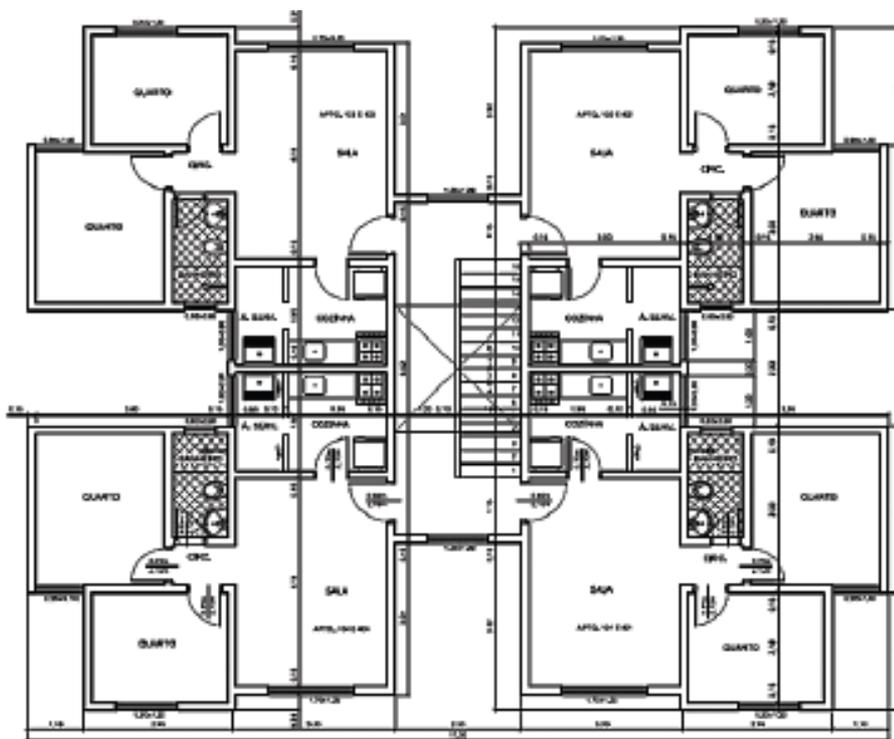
Planta baixa dos pavimentos dos apartamentos com 37m² (tipologia 2)
